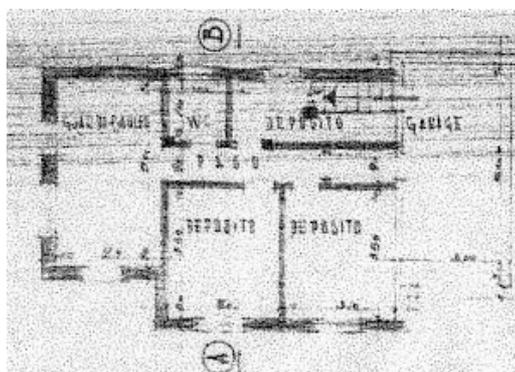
Planta Vivienda en Pinamar, 1950. Proyecto constructor Hércules Foresti. (Archivo Municipalidad Gral. Madariaga)
